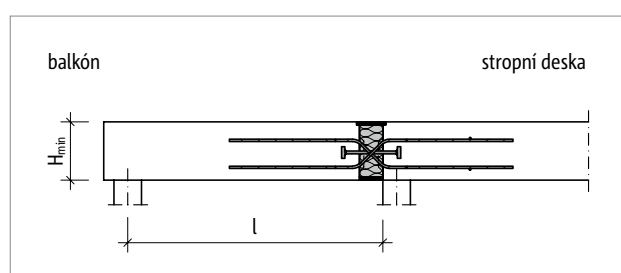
Schöck Isokorb® T typ QP-Z, QP: Statický systém
